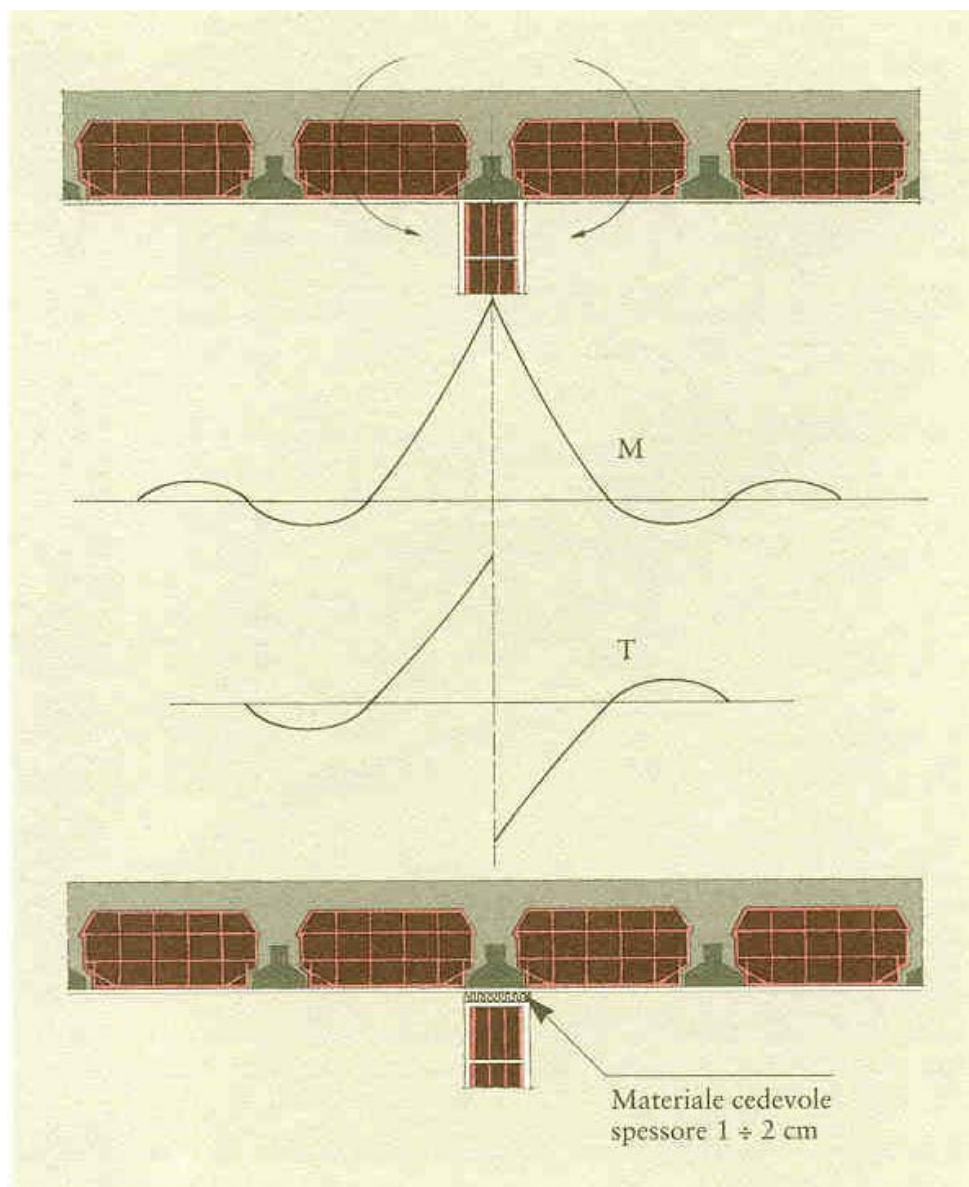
Inflessione del solaio appoggiato su strutture eccessivamente deformabili.
